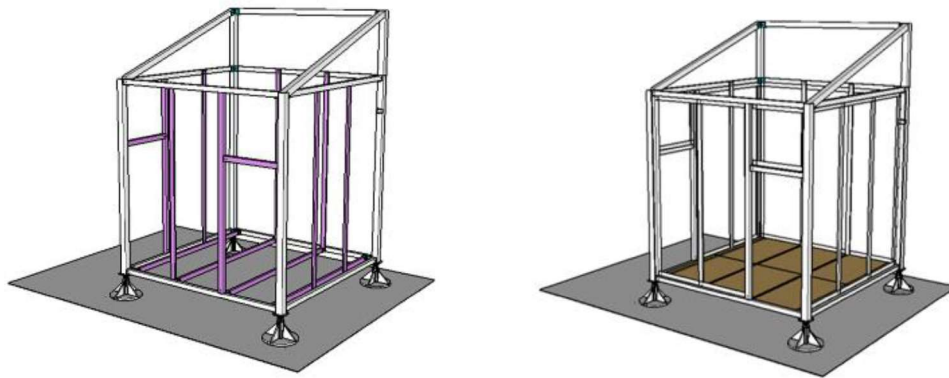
Estrutura do modulo de abrigo pilares vigas de travamento
